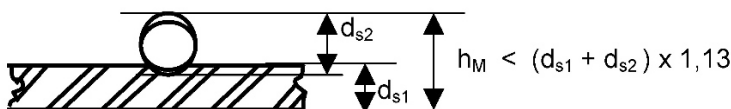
Verschweißung einer Kreuzung zweier Betonstahlstäbe in einer Matte mit etwaiger Höhenangabe.
